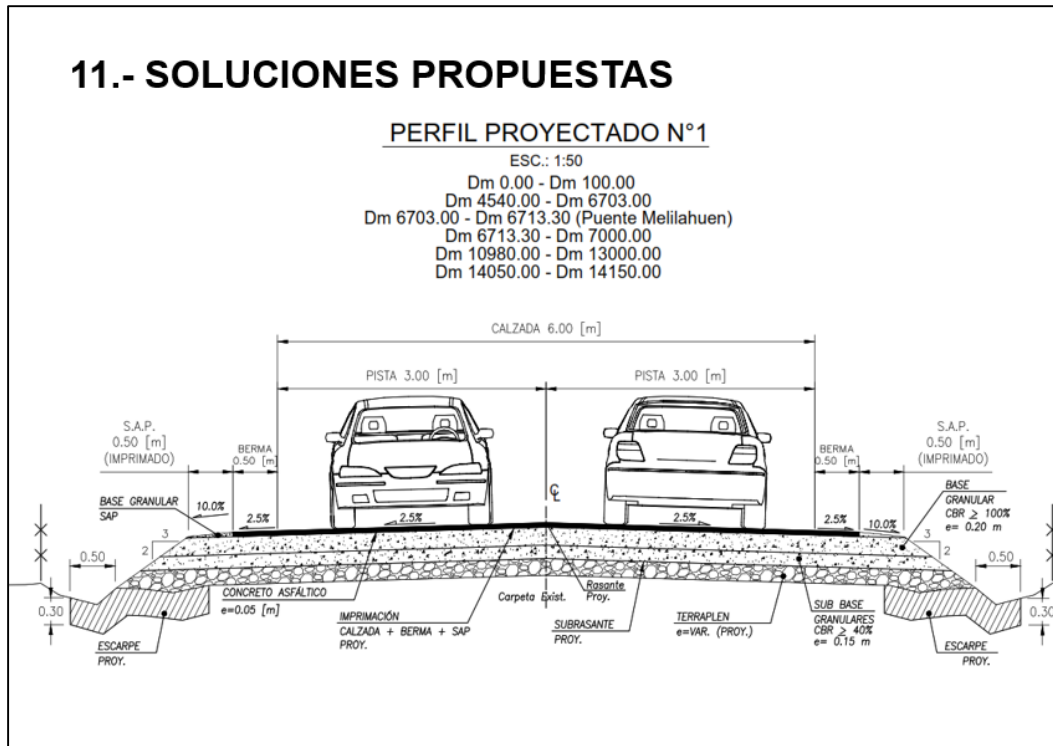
Plano Perfil Projectado Proyecto, N°1.
